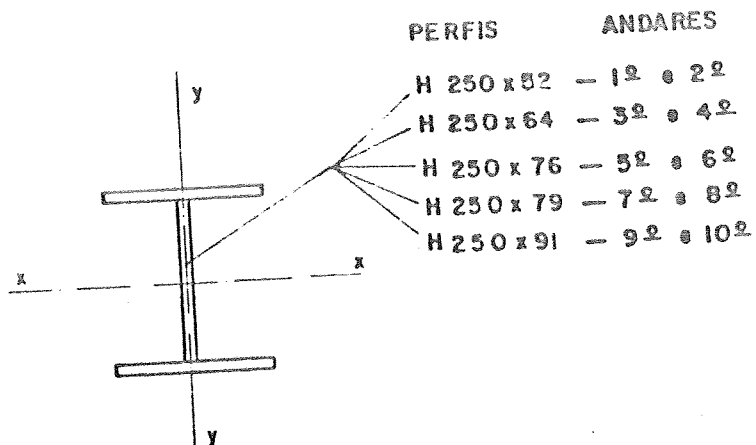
Tipos de perfis adotados para as colunas das estruturas do grupo 1.
